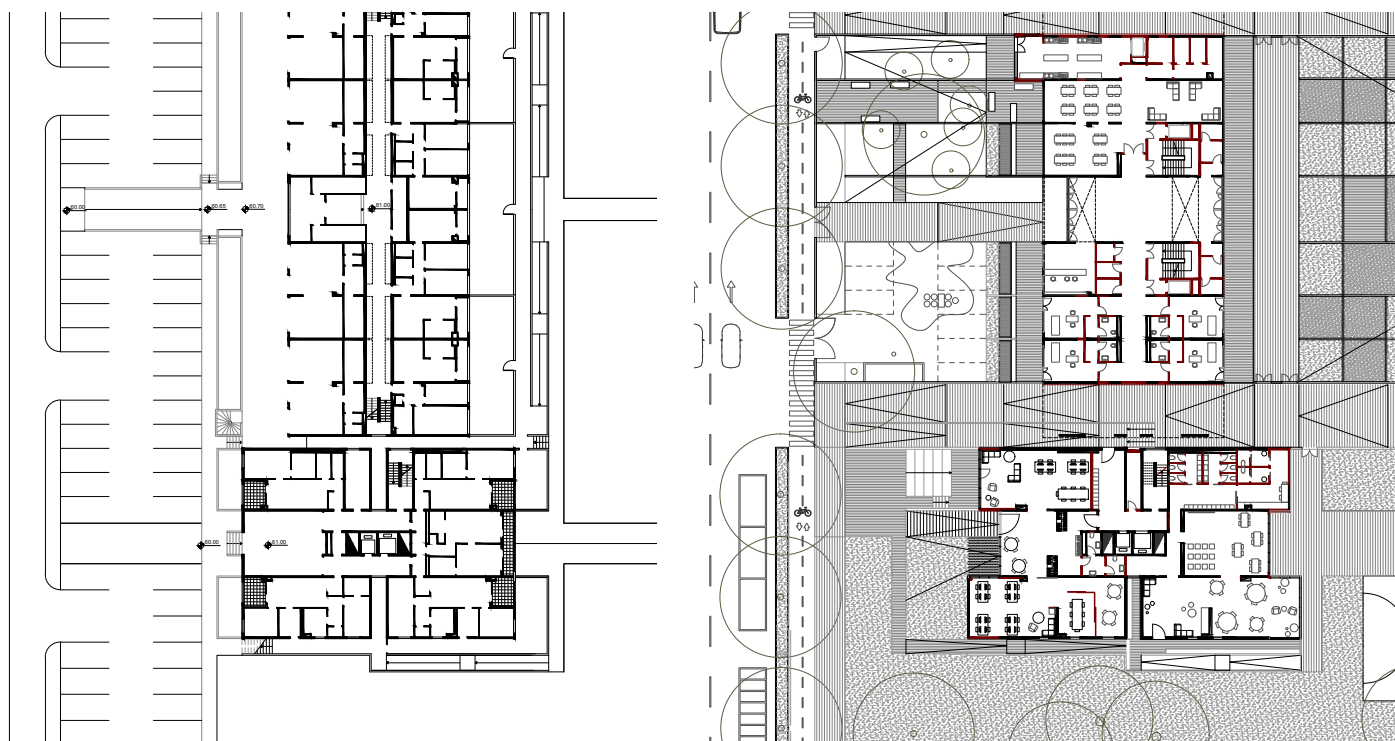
Pianta stato di fatto e stato di progetto di uno stralcio dell'M4
